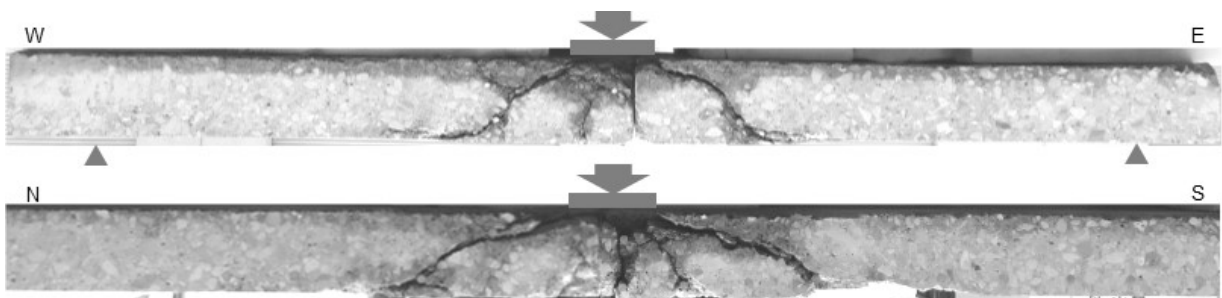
供試体 C の切断面（上：橋軸直角 下：橋軸方向）
